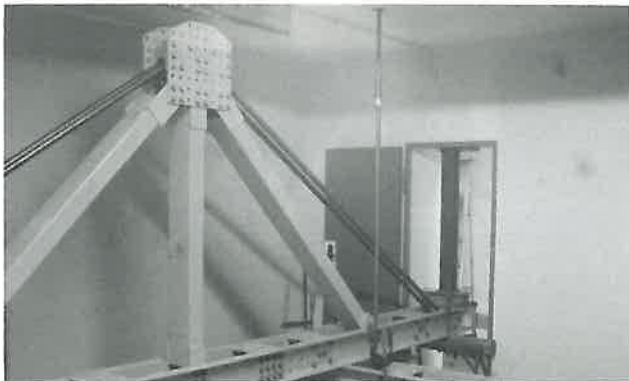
Zerlegbare Belastungsrahmen mit Rückverankerung in Türloibungen...
